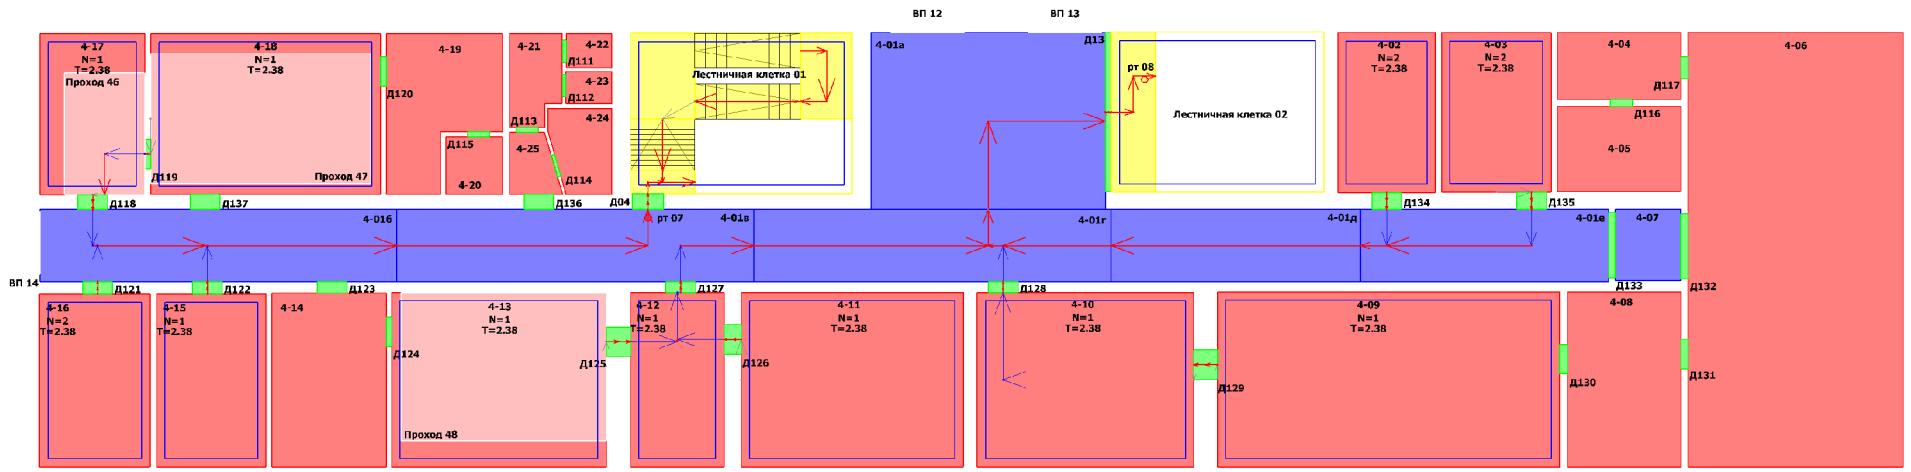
Расчетная схема эвакуации из помещений 4-го этажа здания Администрации
